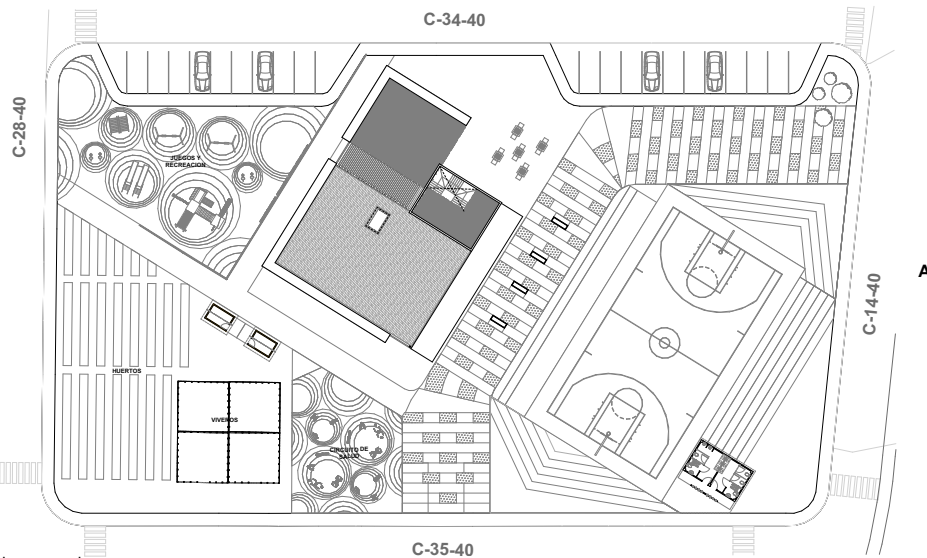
Escala Barrial - Emplazamiento Equipamiento
